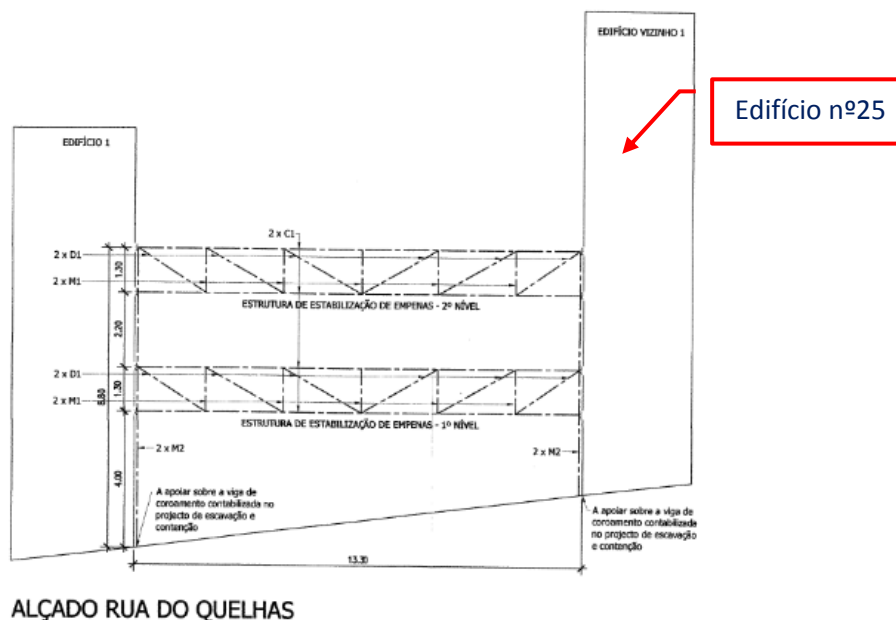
Alçado das vigas treliçadas (visto da Rua do Quelhas)
